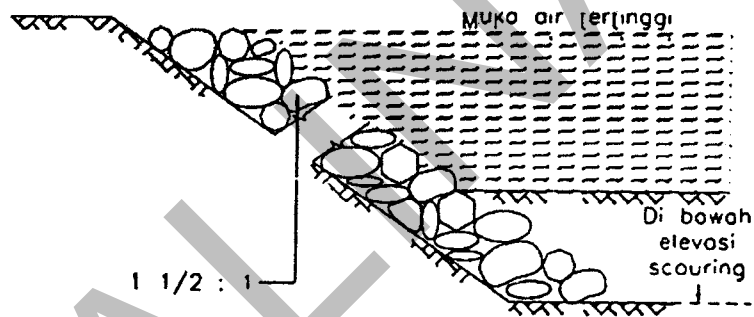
Denah Pemakaian Bronjong untuk Penanganan scouring tanah timbunan
